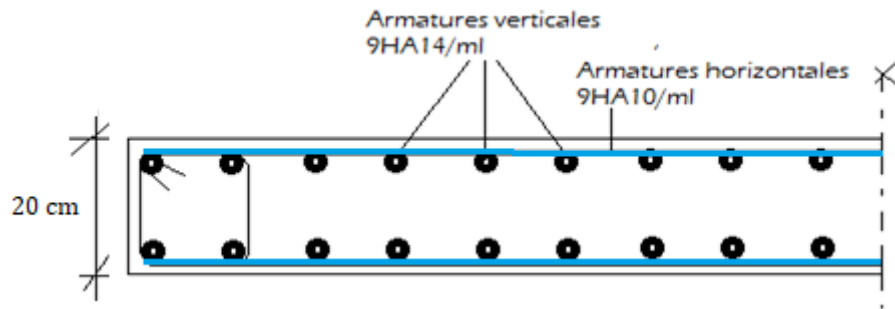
Coupe longitudinale du schéma du ferrailage des voiles.
